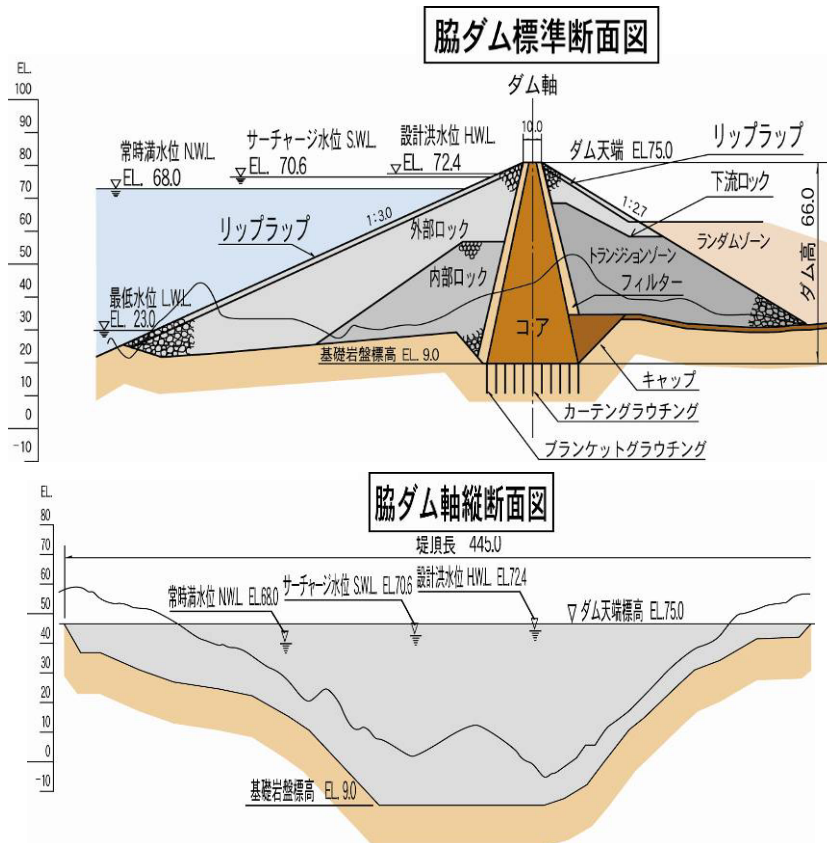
大保脇ダム 標準断面図・軸縦断面図
